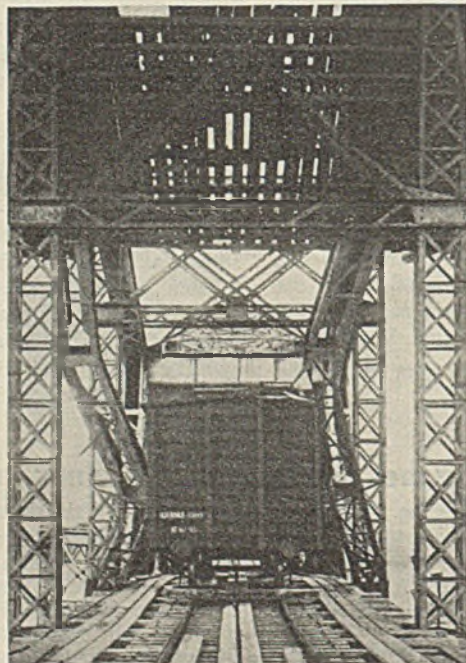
Formänderung der Streben. Ansicht längs der Brücke.
